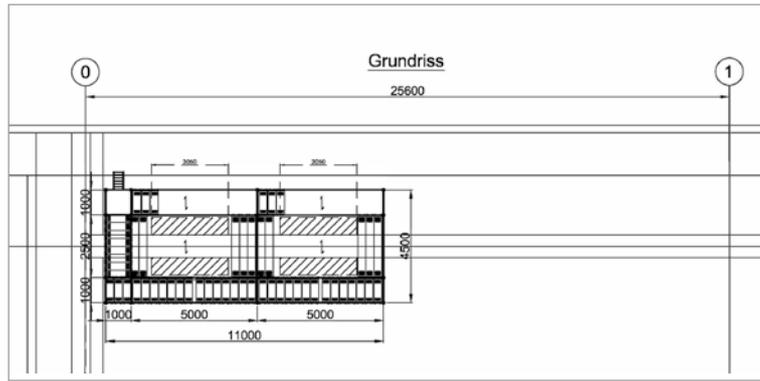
Grundriss eines Hängegerüsts, das unter anderem als Zugangs-, Arbeitsgerüst und Traggerüst eingesetzt wird, Quelle: Ingenieure Tomshöfer & Partner, Bochum
